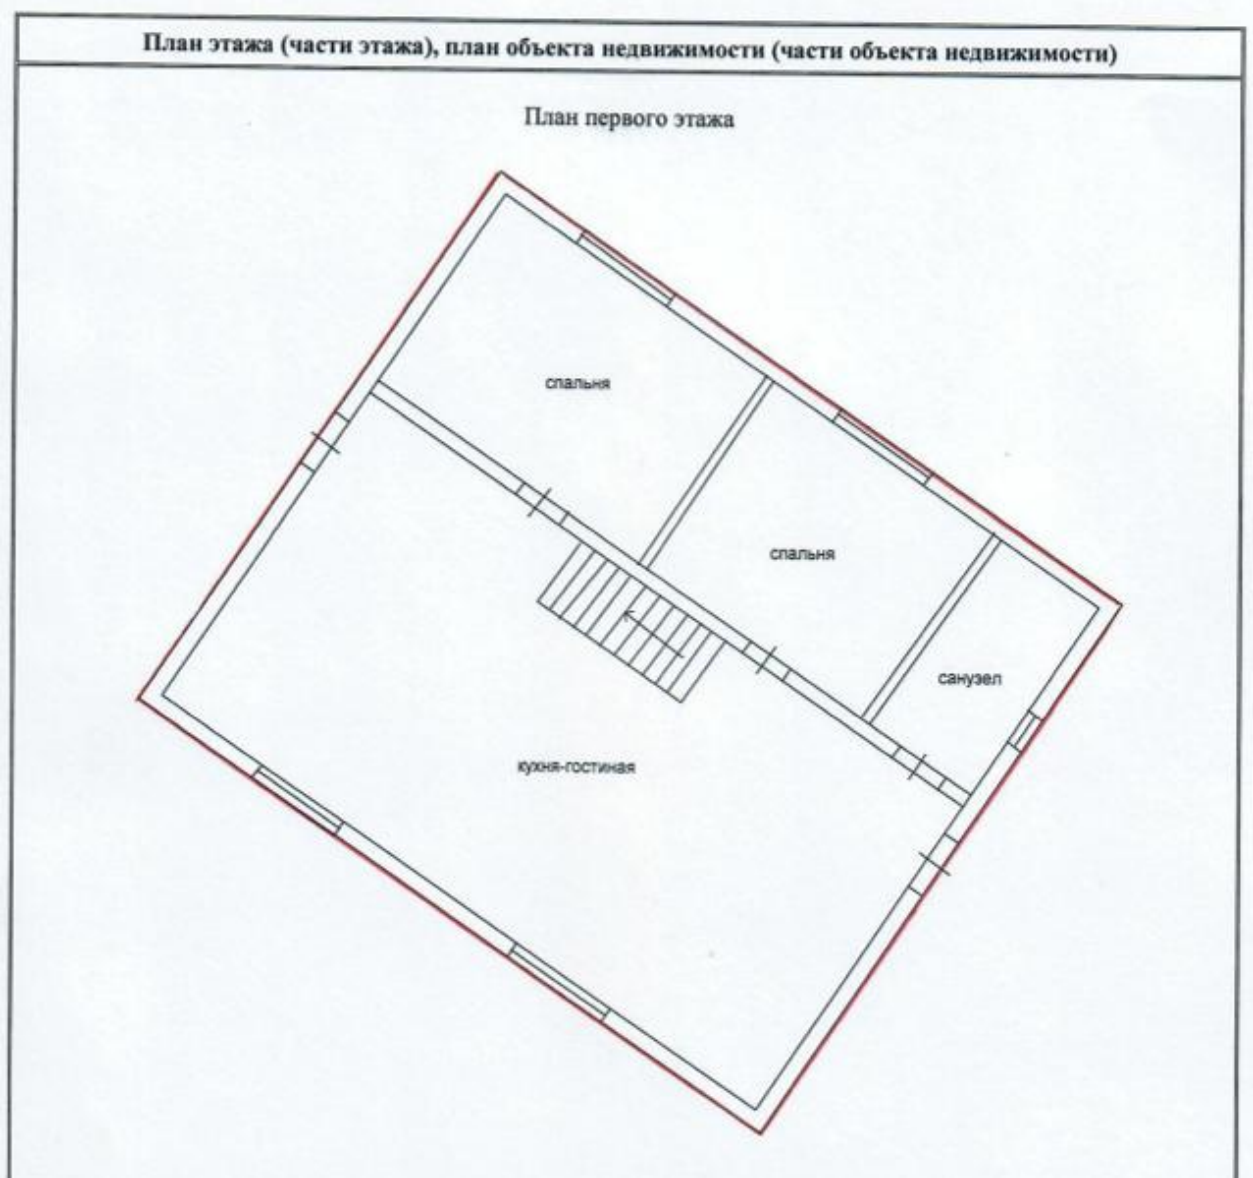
отсутствие на Плане этажа линейные измерения (п.62 Требований к ТП)
